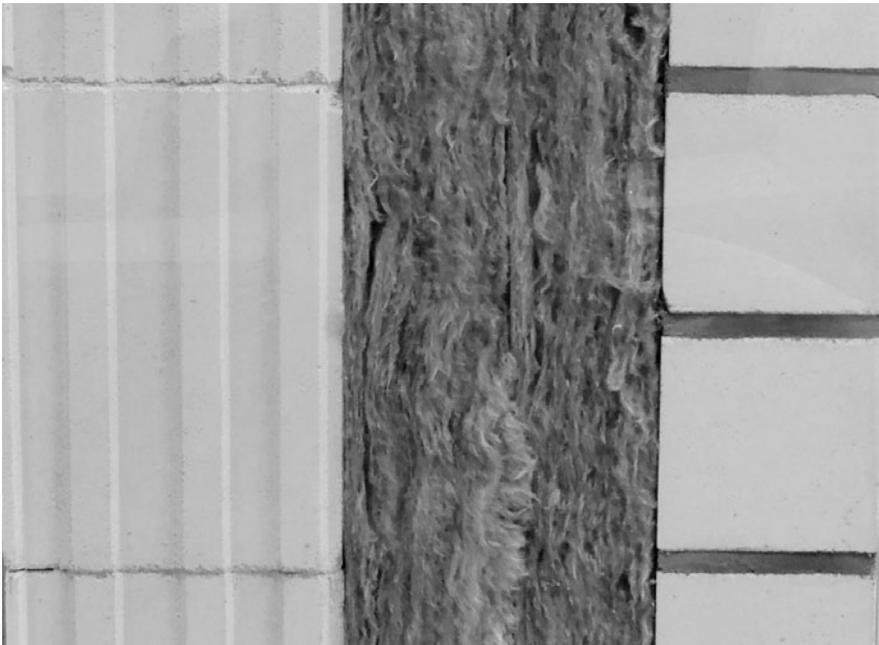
/2: Zweischaliger Wandaufbau mit Hintermauerung, Dämmung und Verblendung
